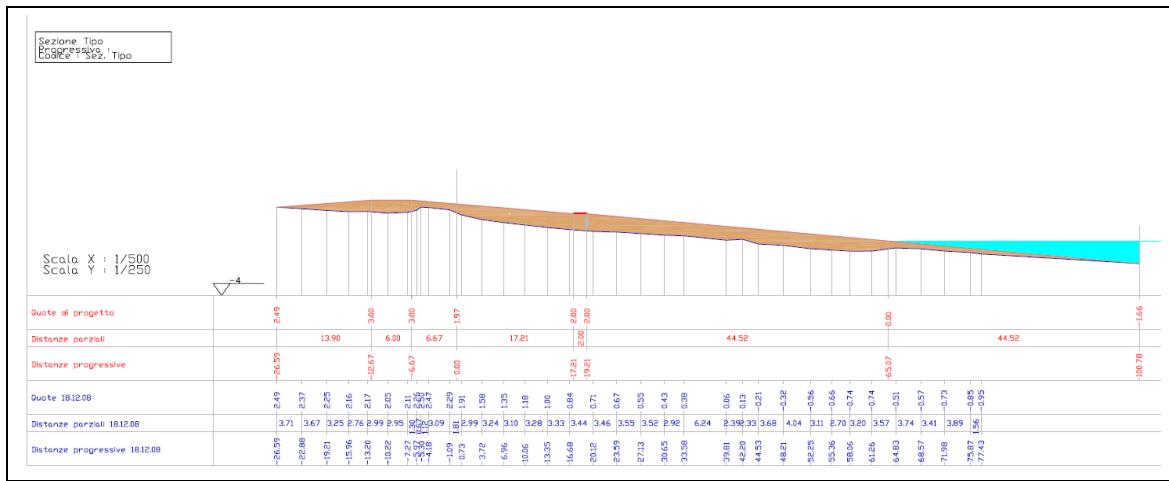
Sezione tipo intervento progetto esecutivo interventi di ripascimento 2011
